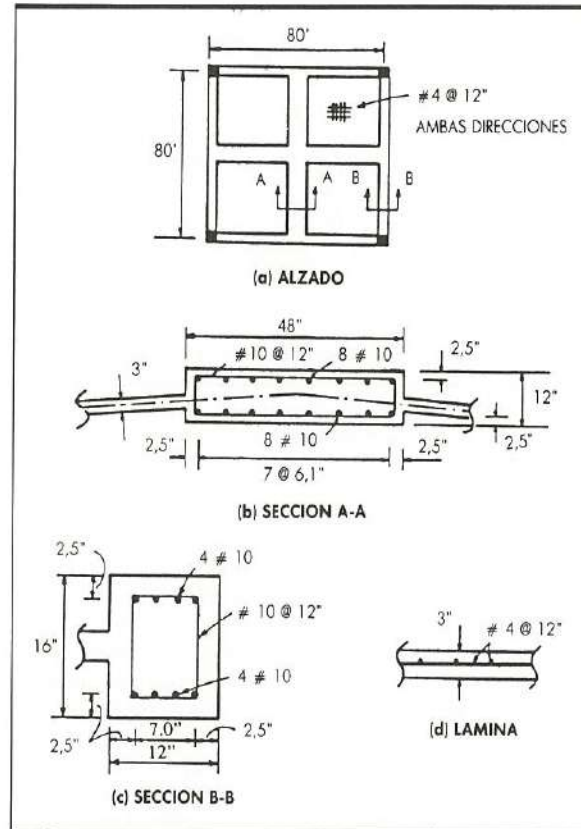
EJEMPLO 4. Armaduras en la lámina y las vigas de borde.
